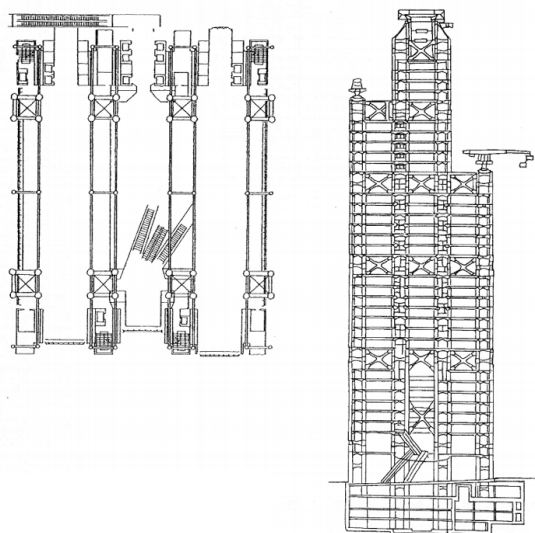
c, d, e, f Widok elewacji frontowej(a), widok ramy konstrukcyjnej na elewacji (b, c, d)
